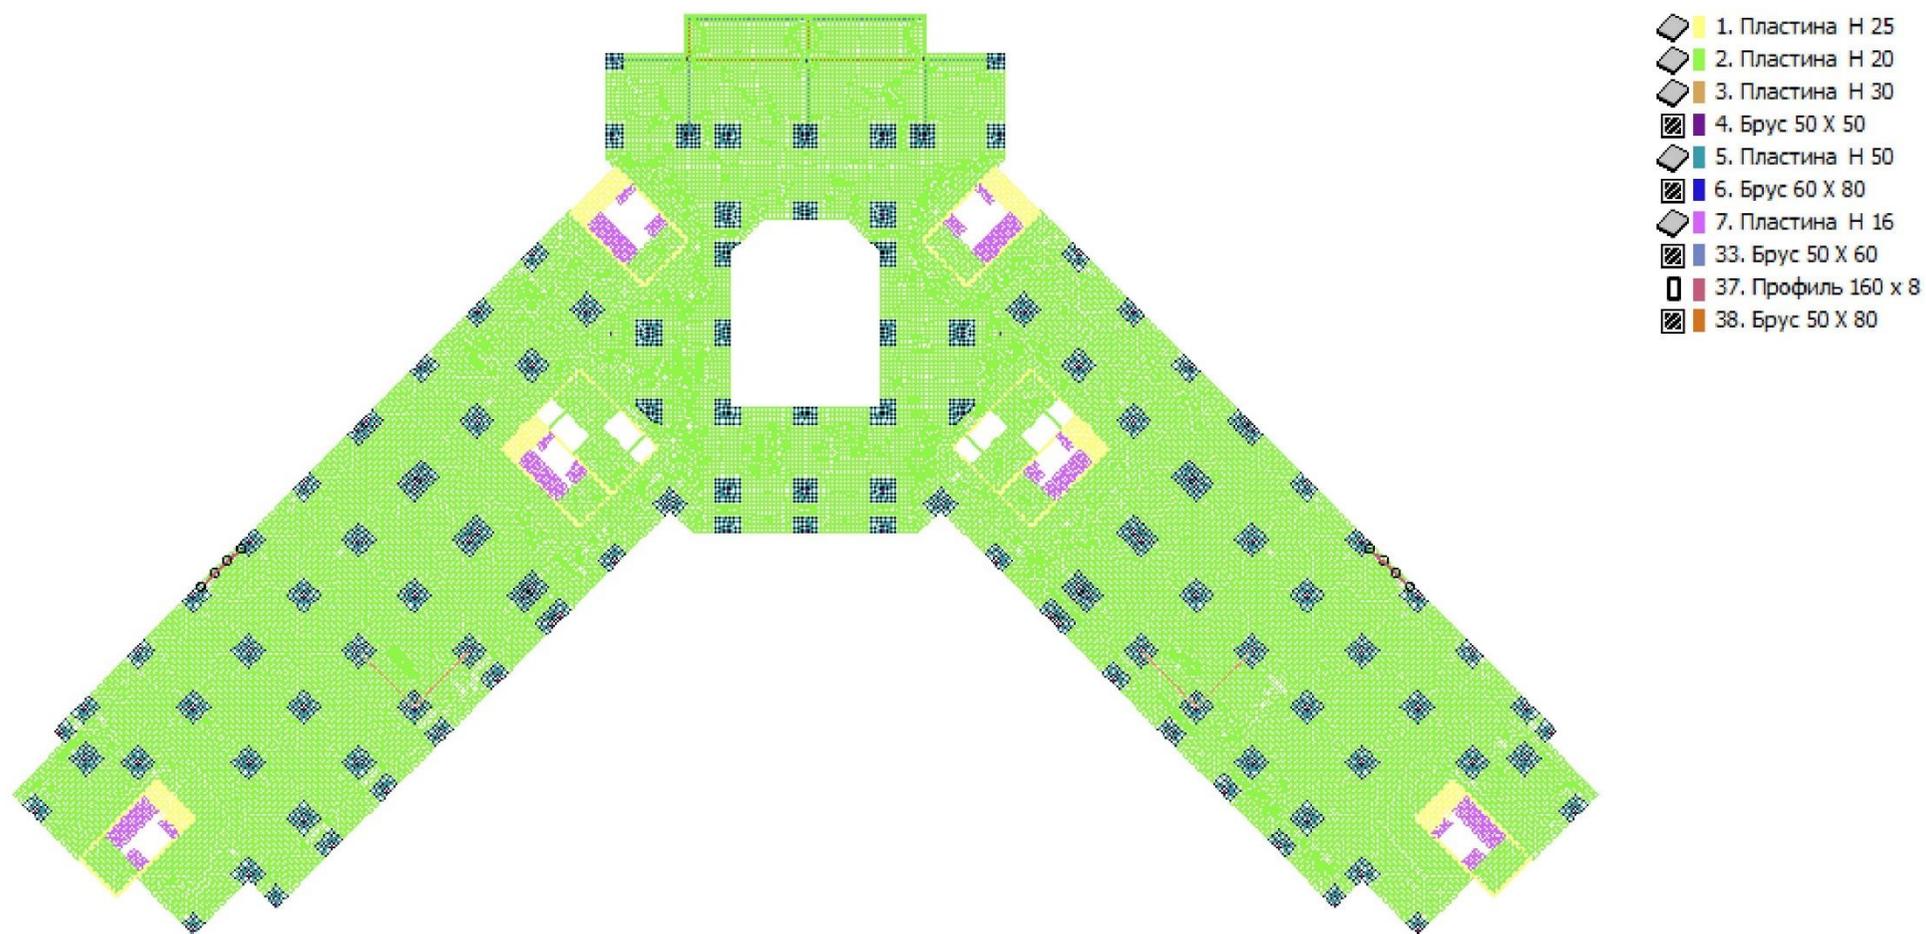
Типы жесткостей элементов. План типового этажа
